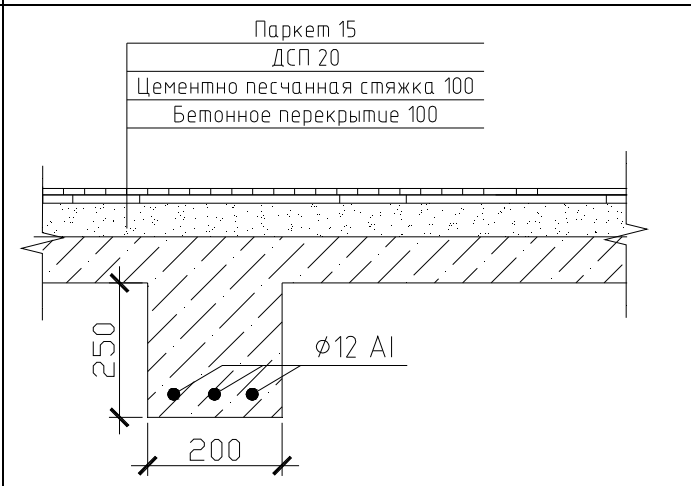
Второстепенная балка ж/б перекрытия над третьим этажом в осях «3–7/Г–Е»
